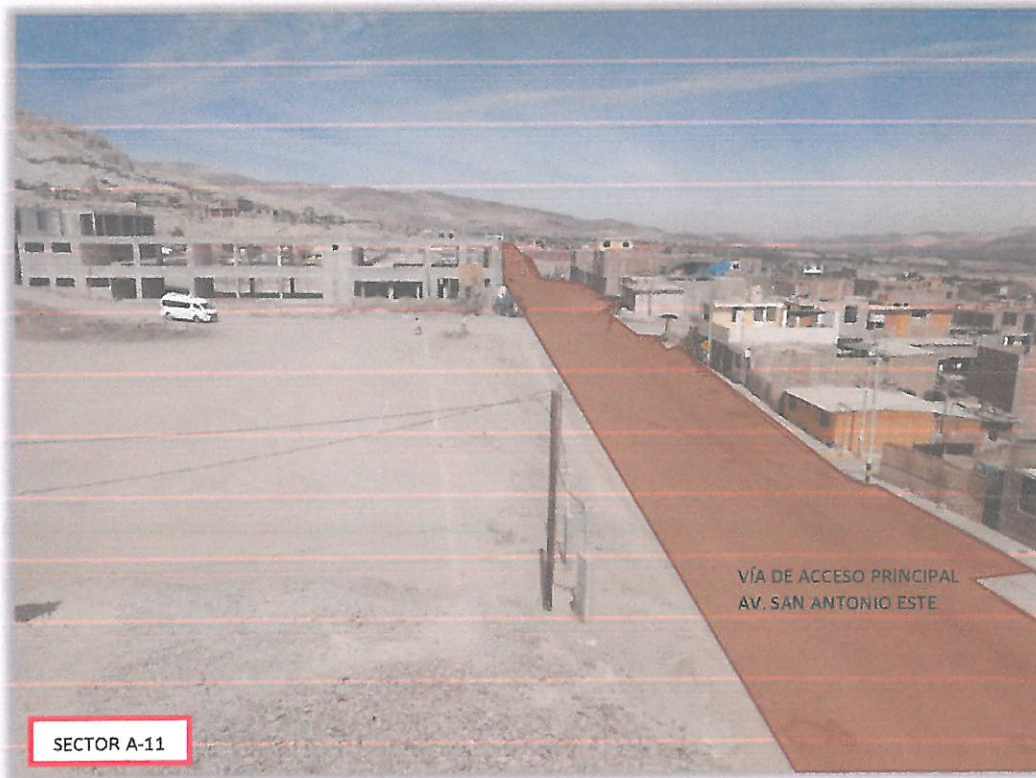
Vista hacia el norte de la principal a la zona de trabajo denominada Avenida San Antonio Este.
